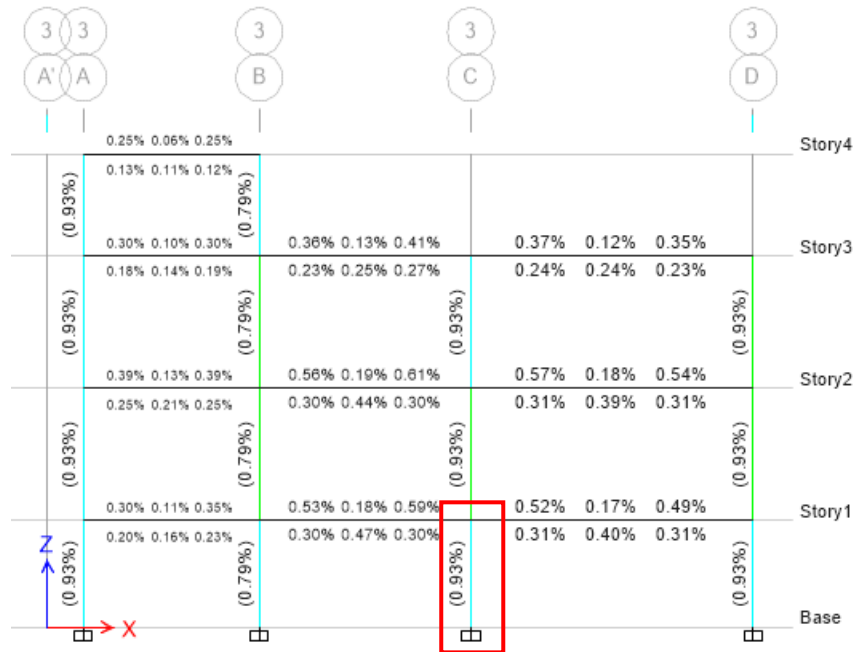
Acero de Refuerzo longitudinal en columnas
